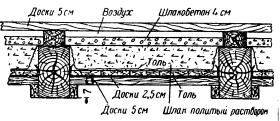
Деревянное перекрытие по Н. И. Быкову.
